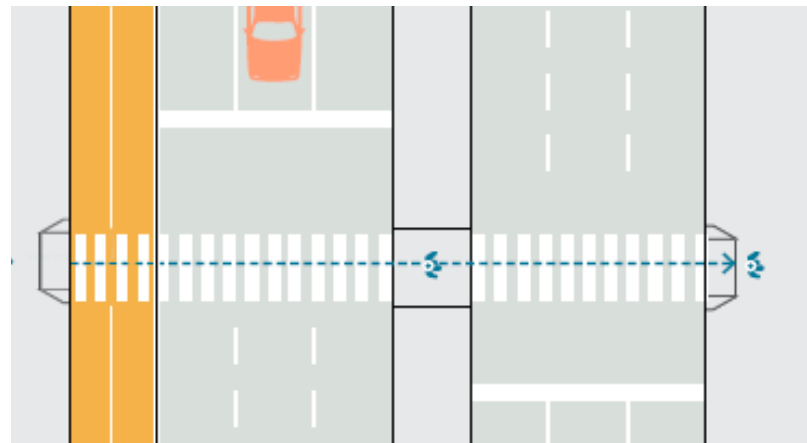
Desenho esquemático de propsta para rebaixo de canteiro
